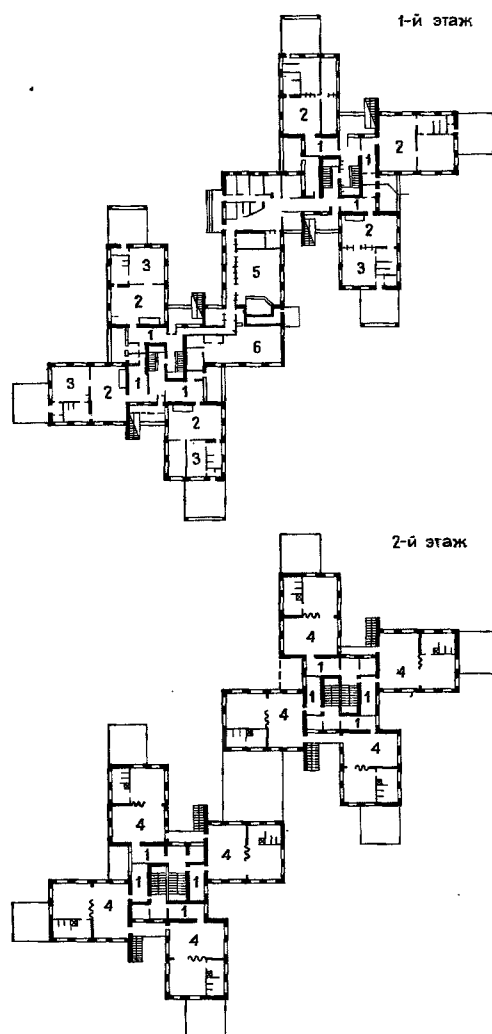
Ясли-сад на 320 мест в г. Тольятти. Планы этажей
